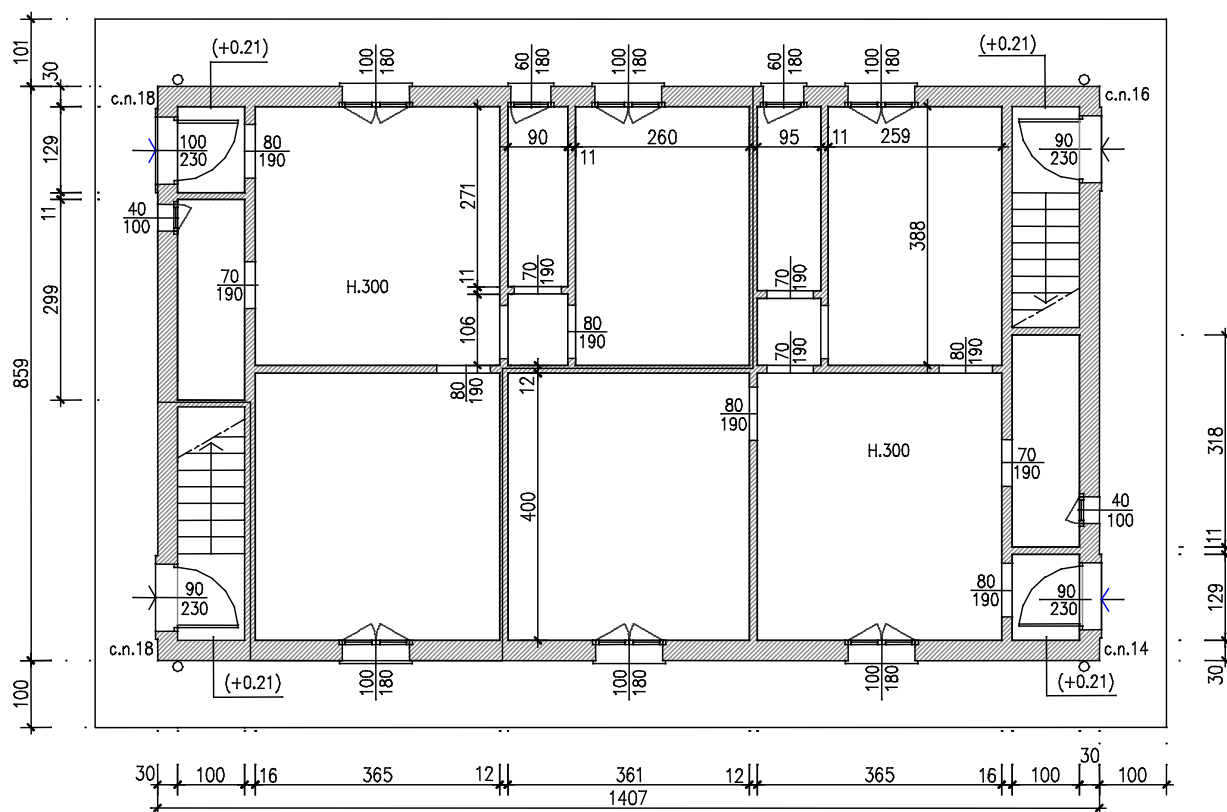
PALAZZINA TIPO C: Pianta Piano Terra – Stato di Fatto
